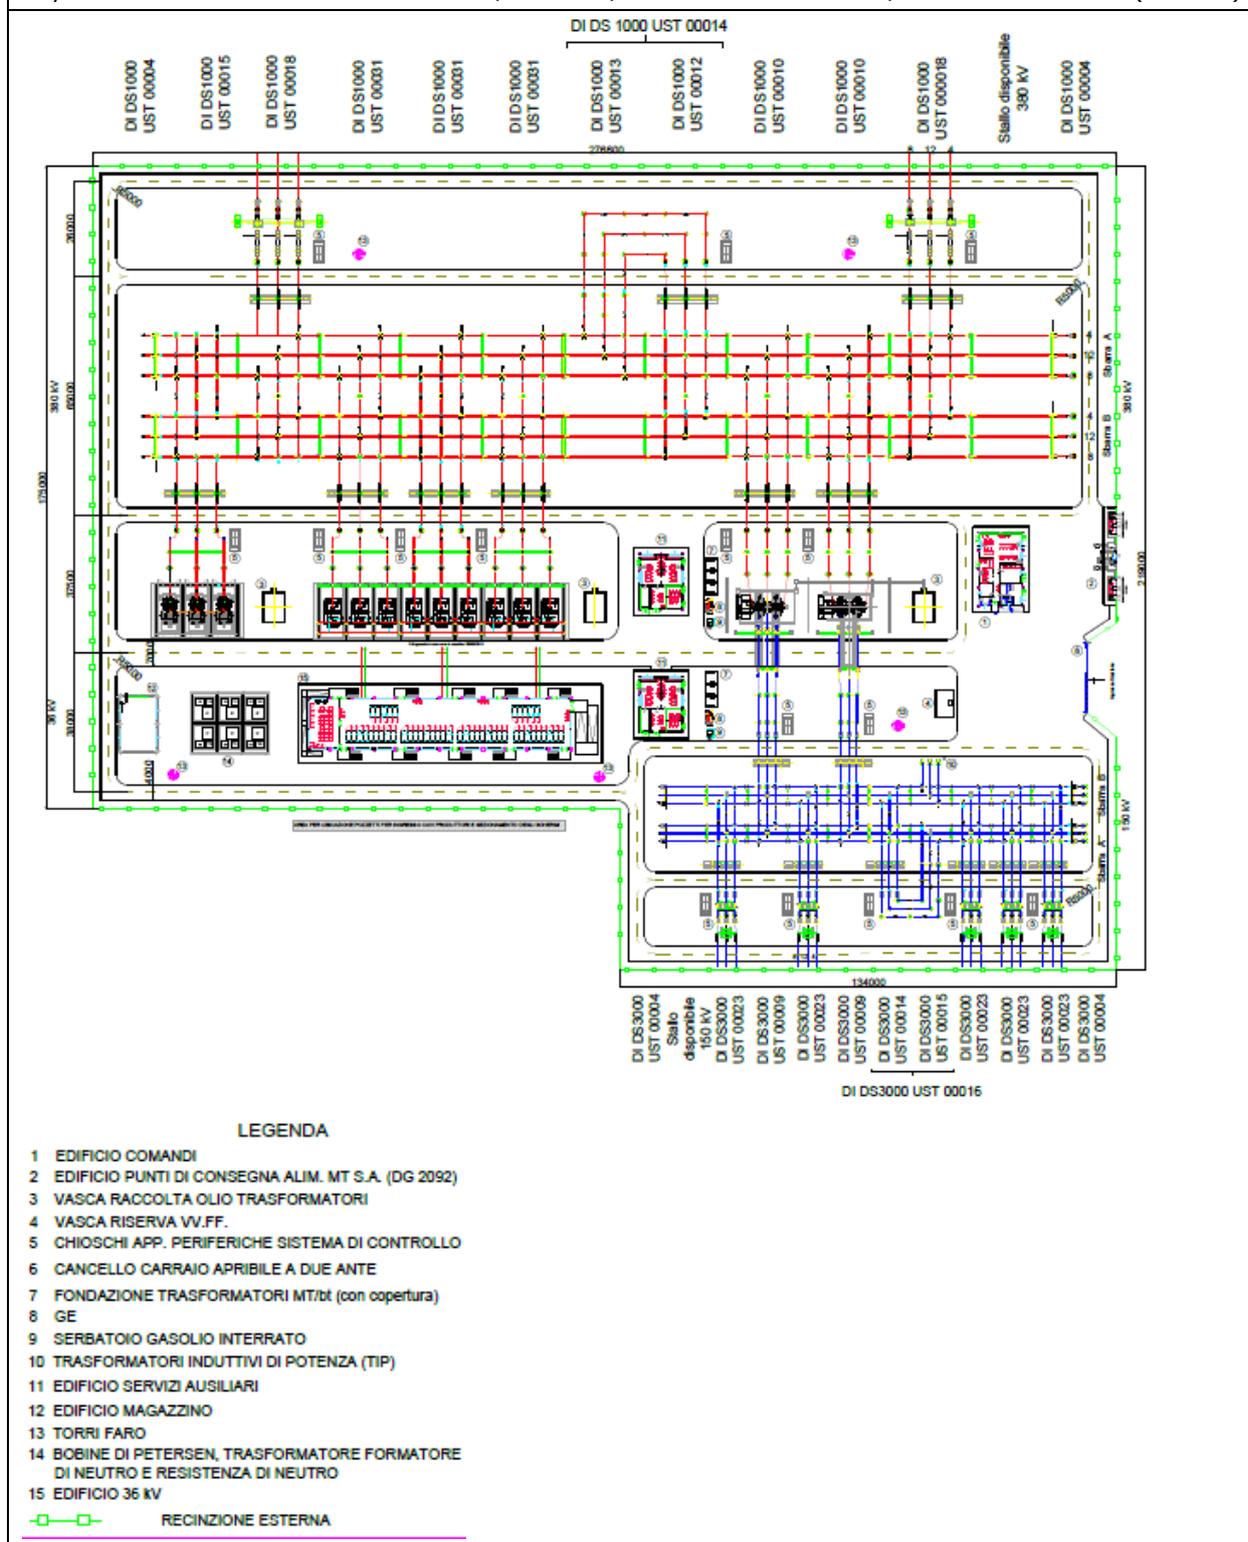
Planimetria della nuova stazione elettrica di Terna
